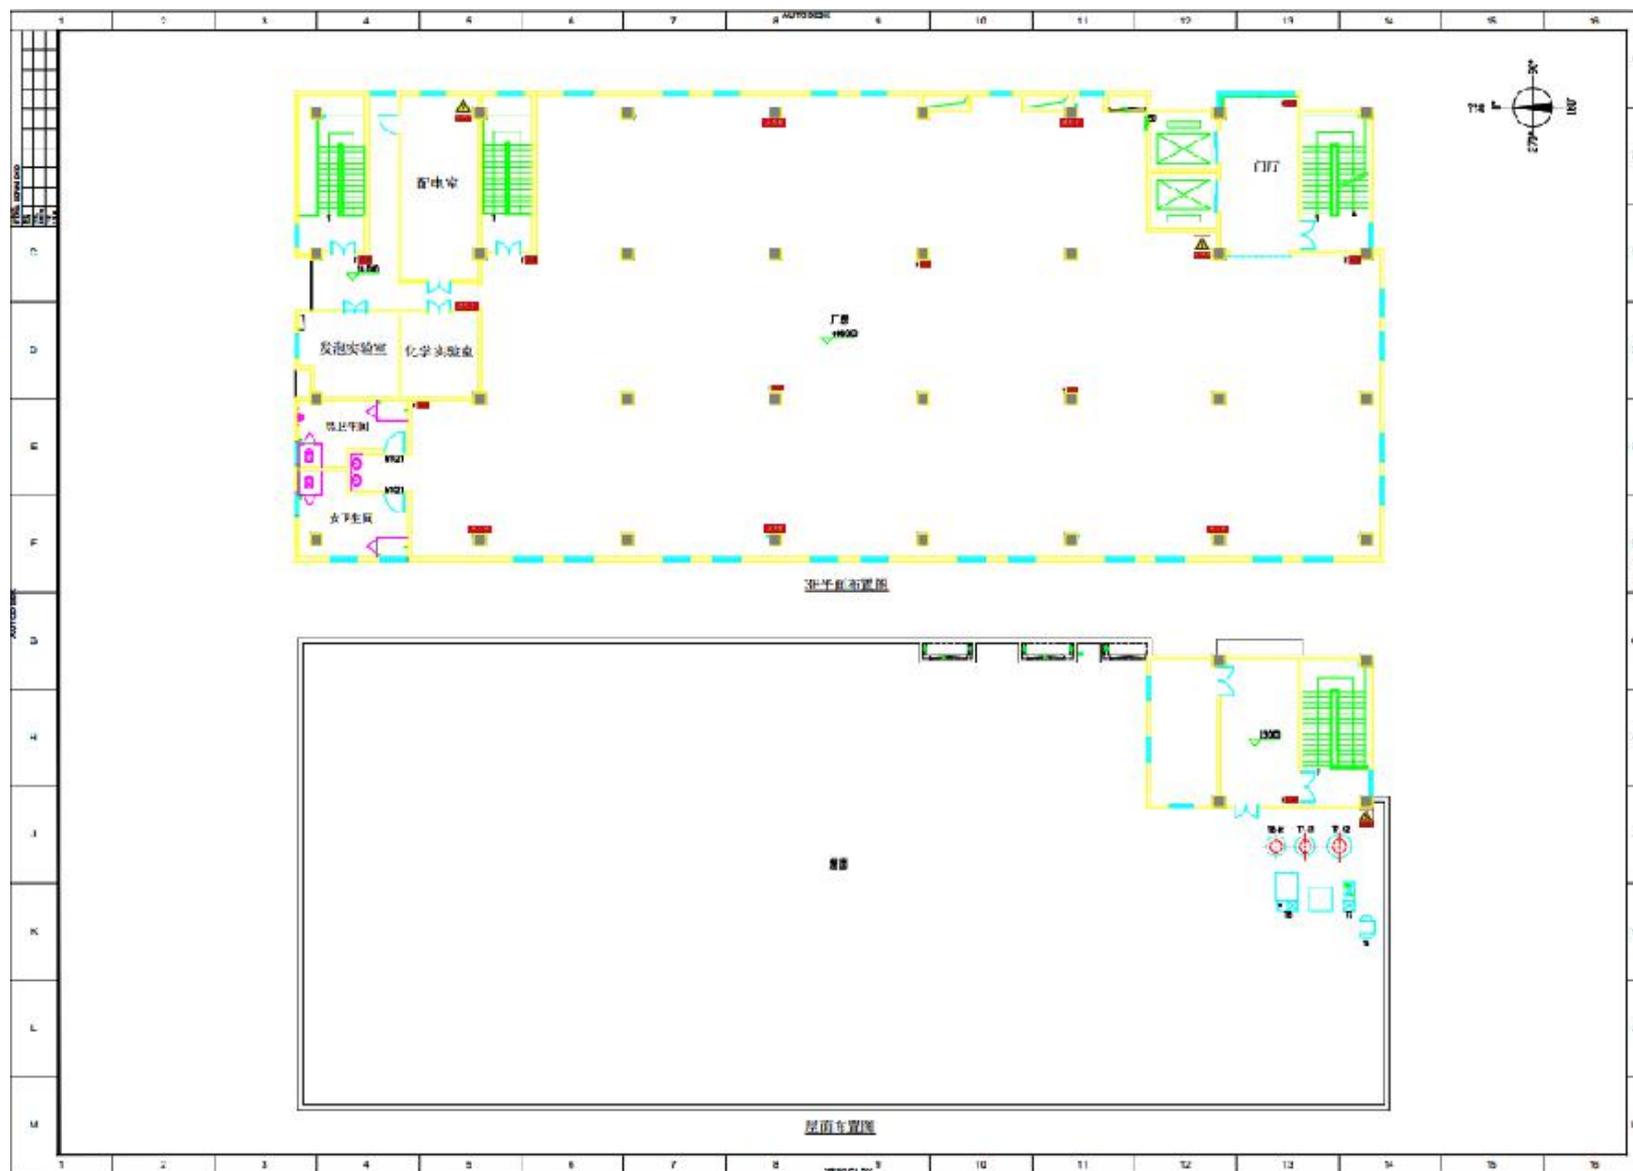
建设项目厂房三楼和屋面平面布置图
